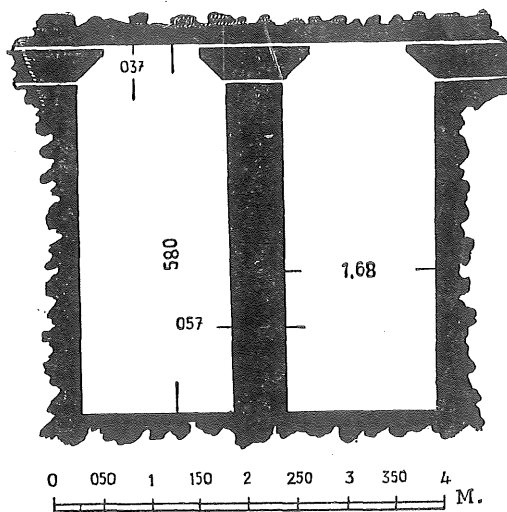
Mérida (Badajoz). Sección transversal de la escalera de bajada al aljibe y longitudinal de la cámara de acceso. — Dibujo de F. Hernández.
